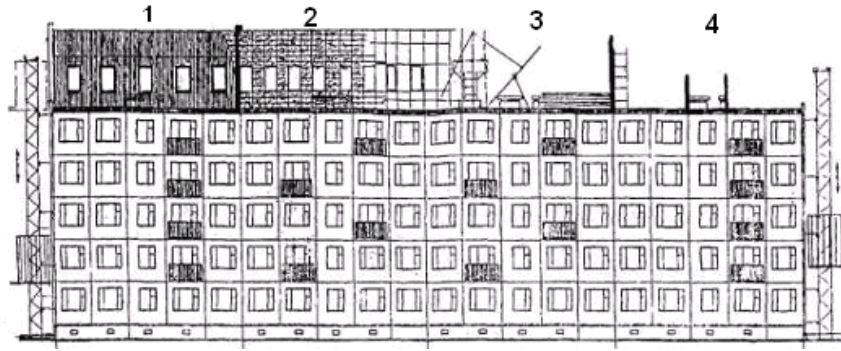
Поточное производство работ по возведению мансардного этажа: 1 – устройство кровельного покрытия и оконных заполнений; 2 – сплошная обрешетка по стропилам и прогонам с установкой утепляющего слоя; 3 – монтаж каркаса; 4 – кирпичная кладка лестничных клеток и внутренних межсекционных стен.
